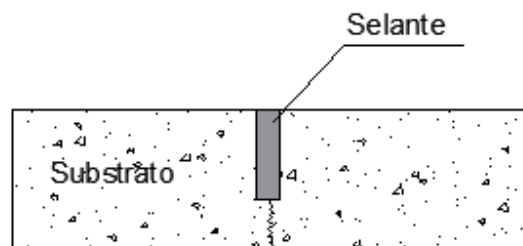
Corte esquemático das fissuras seladas
